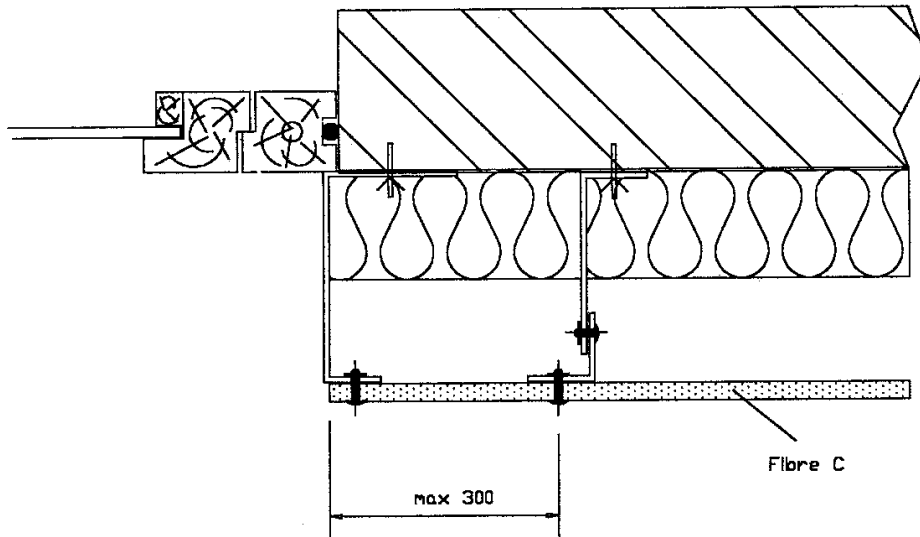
Encadrement de fenêtre (coupe sur tableau)
